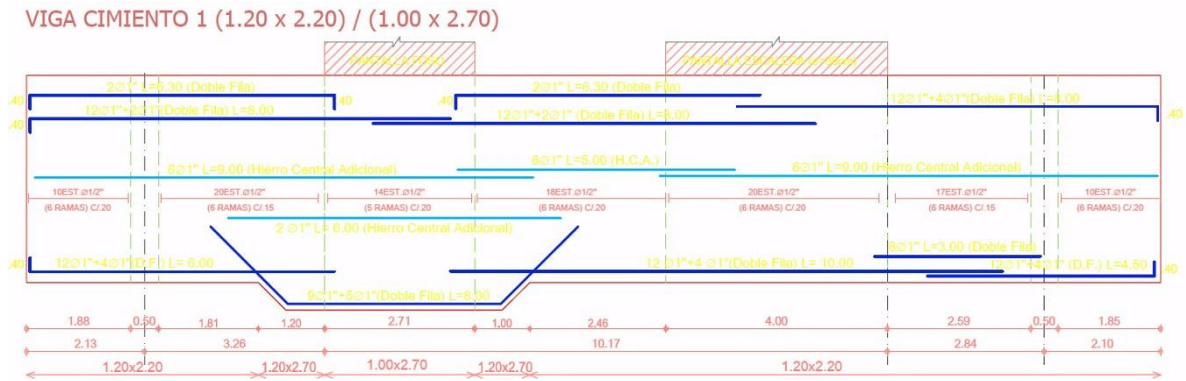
Ejemplo de despiece para una viga cimiento tipo 1 perteneciente a la losa de cimentación PC-1(1.2 x 2.2 ó 1.0 x 2.7 m).
